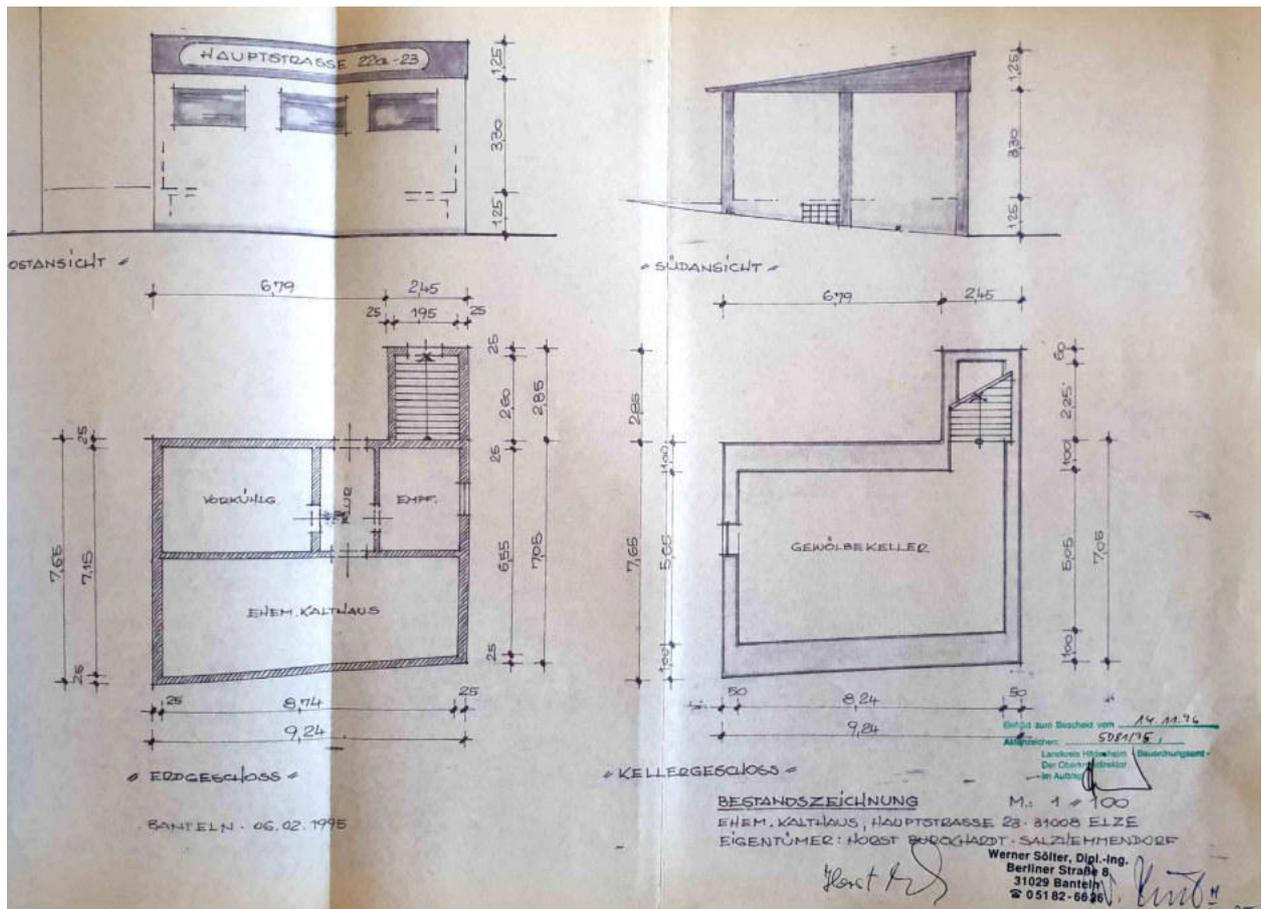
Bestandszeichnung von 1995. Der Plan enthält den Grundriss eines parallel zur Straßenflucht angelegten Gewölbekellers mit rückseitigem Zugang. Das Gebäude wurde als Kühlhaus genutzt.
